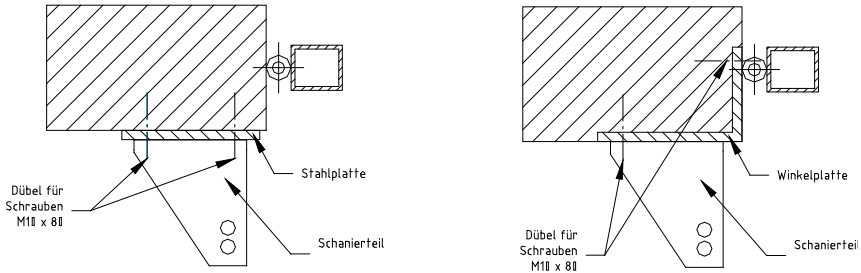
Befestigung des Antriebs am Pfeiler mittels Stahlplatte oder Winkel
